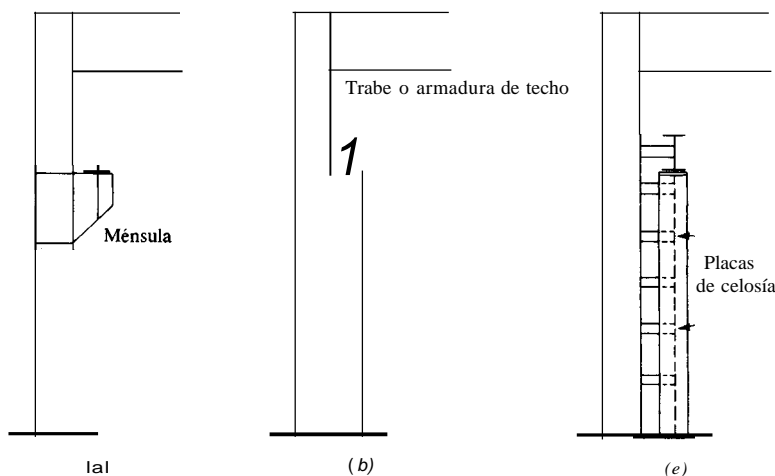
Columnas para grúas en un edificio industrial. (a) Columna con ménsula. (b) Columna escalonada. (c) Columna escalonada, armada.
